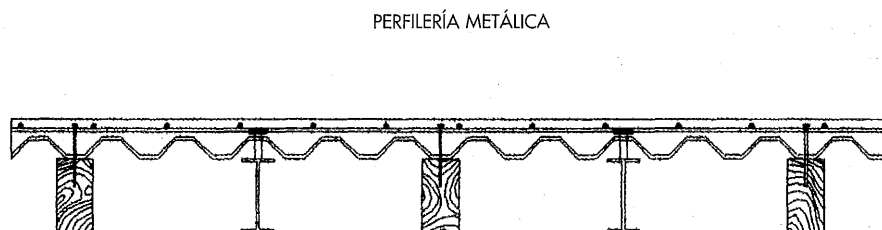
Sustitución funcional de un entrevigado y su capa de reparto por una estructura metálica de perfiles laminados y chapa plegada.
